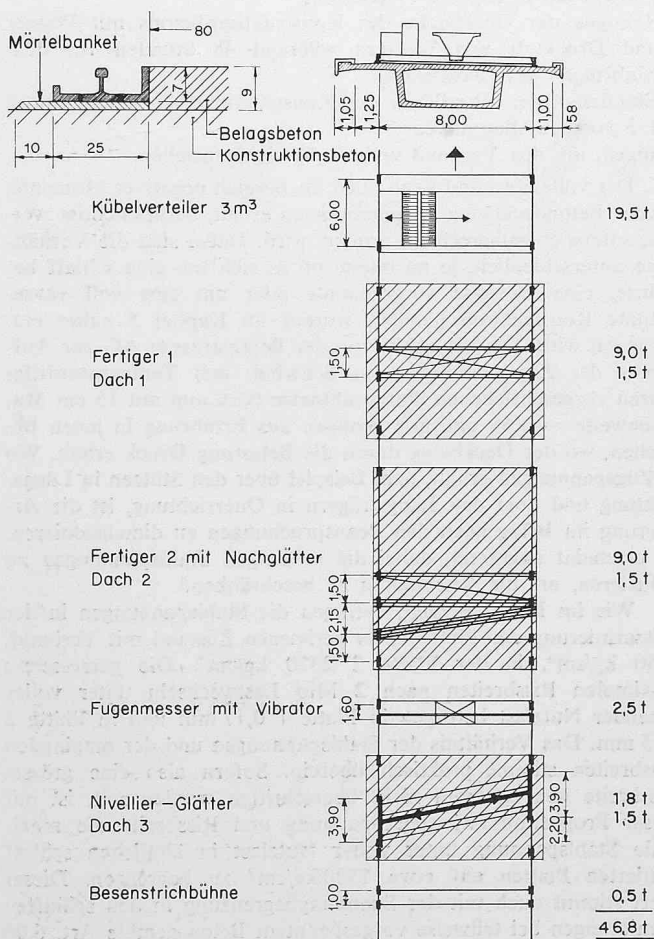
Schema des Einbauzugs, Lage und Gewicht bei einer Einbaubreite von 8 m
